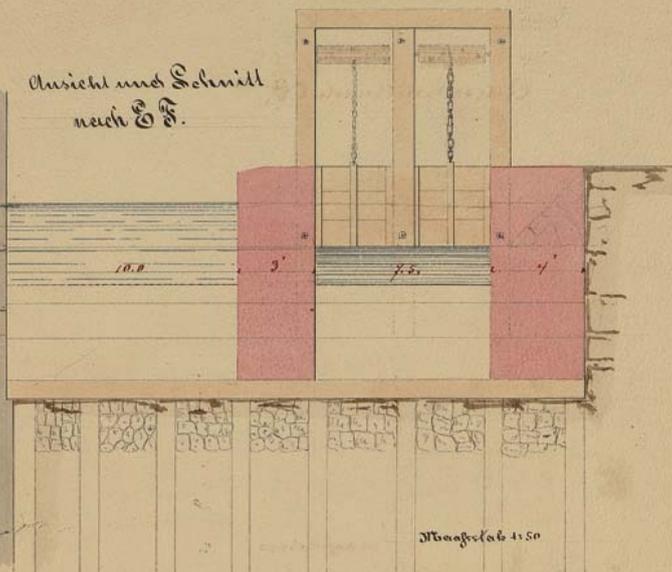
Plan zur Errichtung eines neuen Wehres 1871
